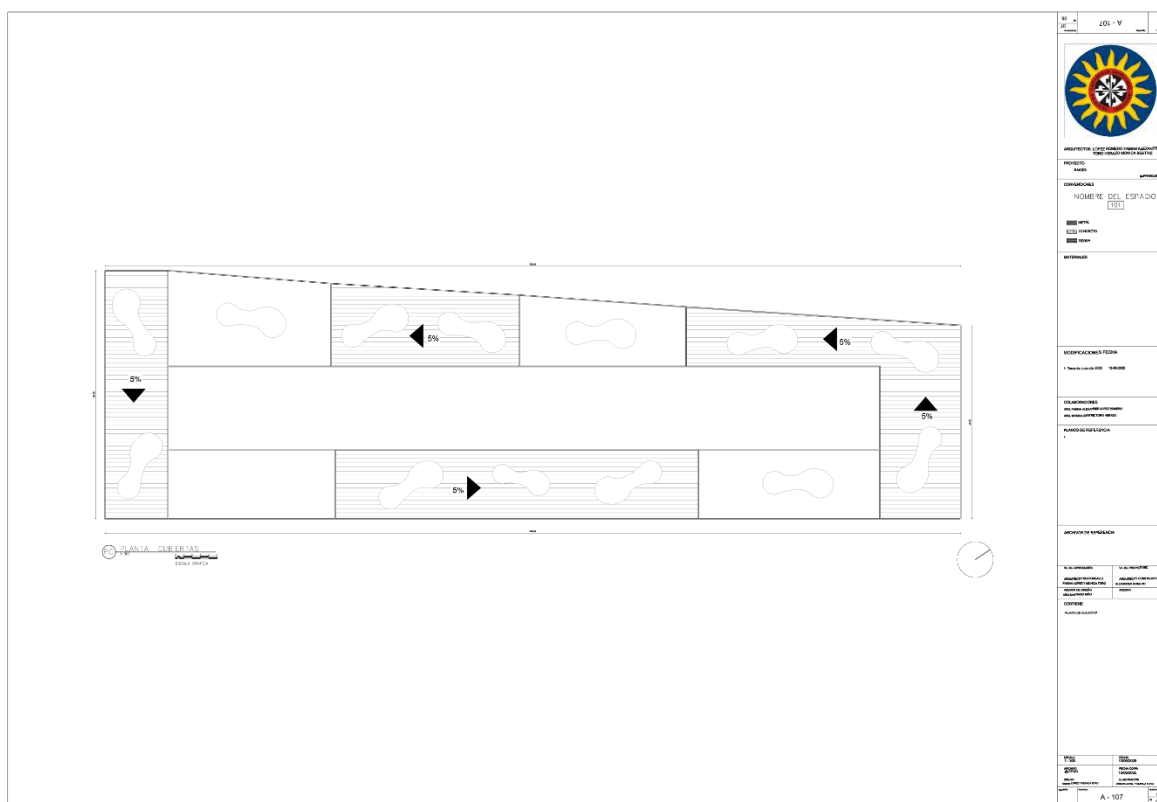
Planimetría Planta Cubiertas. Fuente: Elaboración propia.
